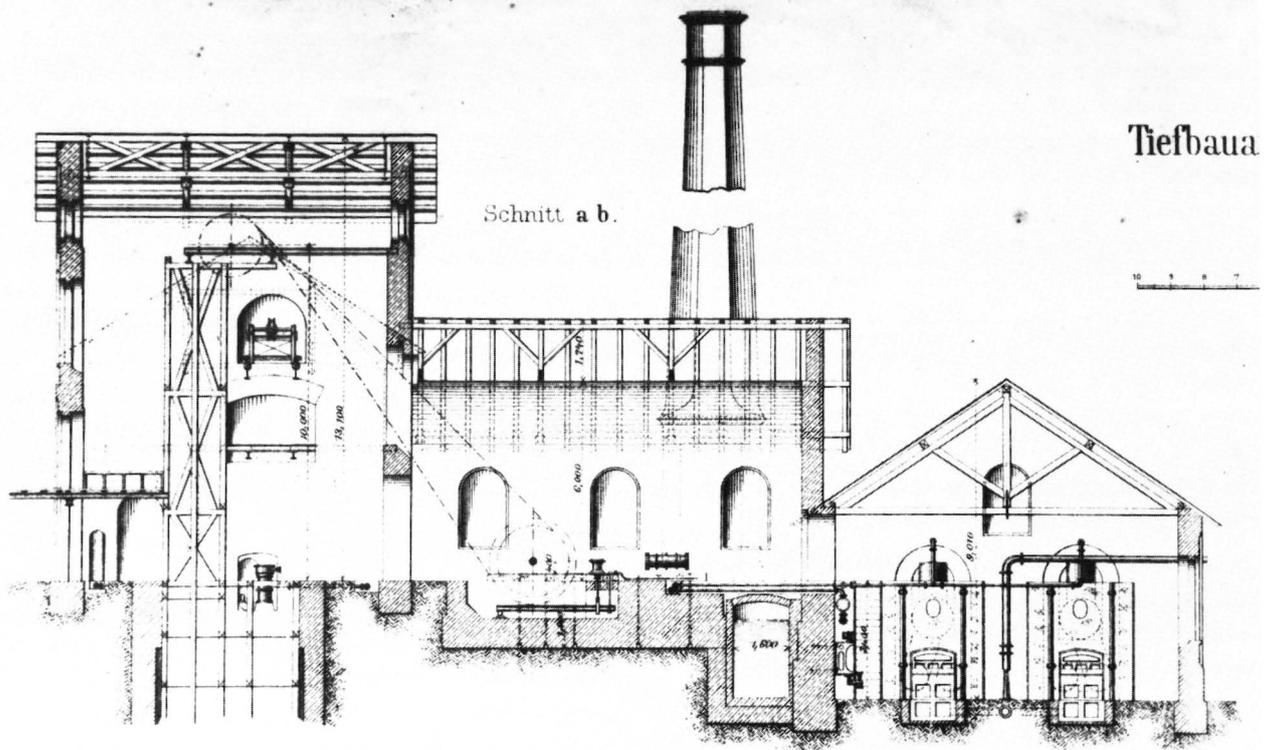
Grube Apfelbaum, Schachtgebäude (1882): Längsschnitt durch die Schachthalle (links), das Fördermaschinenhaus (Mitte) und die Dampfkesselanlage (rechts)
